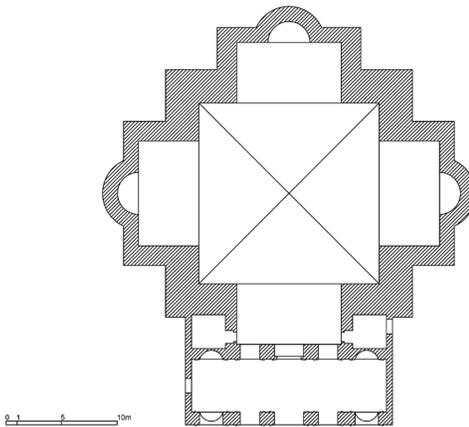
LEON BATTISTA ALBERTI, planta da Igreja de San Sebastiano
